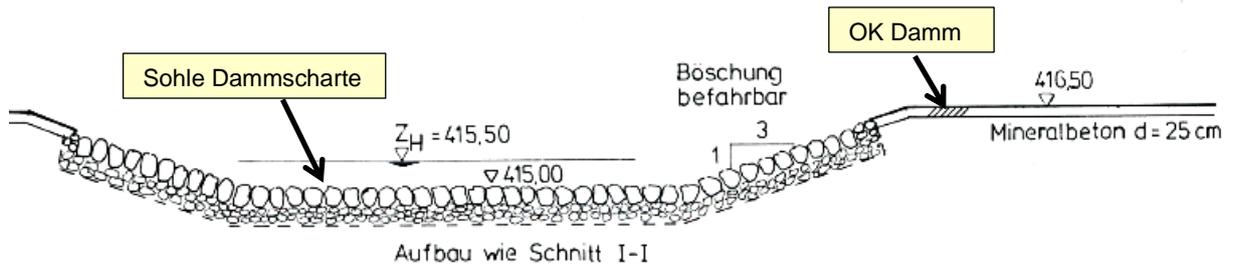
Schnitt längs der Dammkrone mit Dammscharte (Entwurf 1996, Anlage 5-2, Schnitt III-III)
